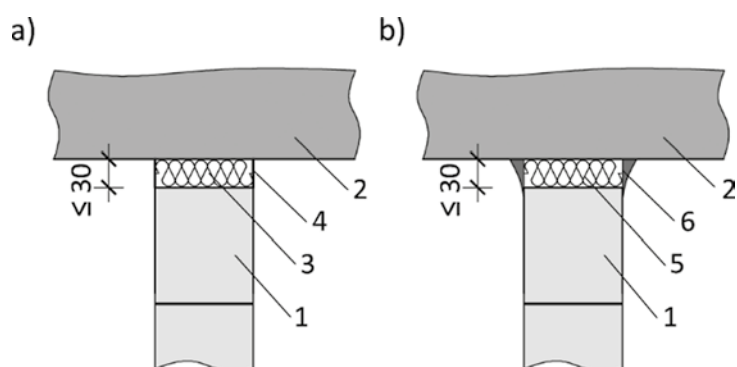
Przykłady podparcia ścian wypełniających elementami żelbetowymi w płaszczyźnie pionowej: a) na „jaskółczy ogon”, b) za pomocą kotew, 1 – murowana ściana, 2 – element żelbetowy, 3 – warstwa izolacyjna z wełny mineralnej klasy A, 4 – uszczelnienie, 5 – tynk, 6 – kotwa zapewniająca przesuw
